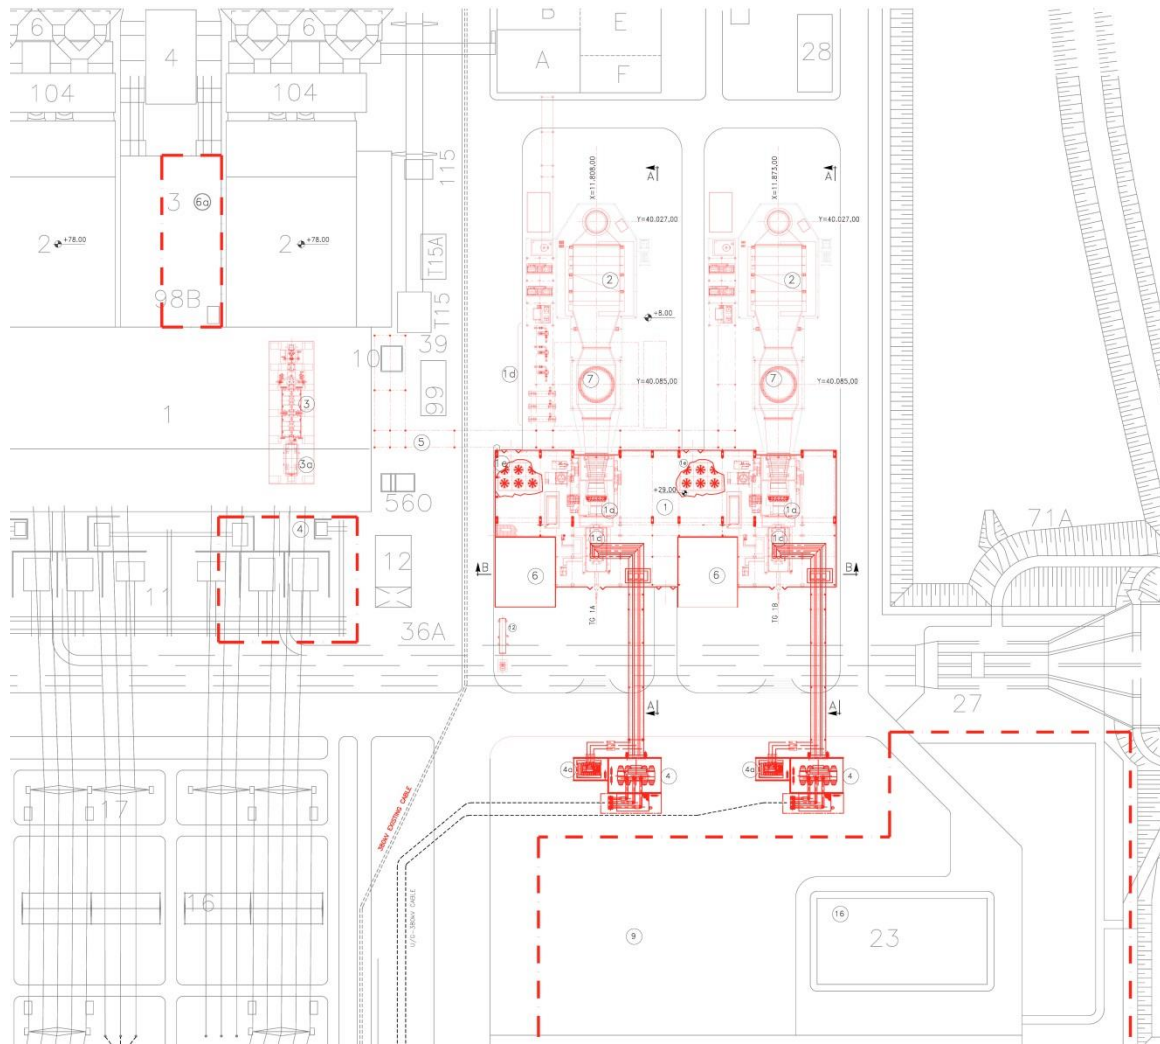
Planimetria attuale della centrale Federico II
